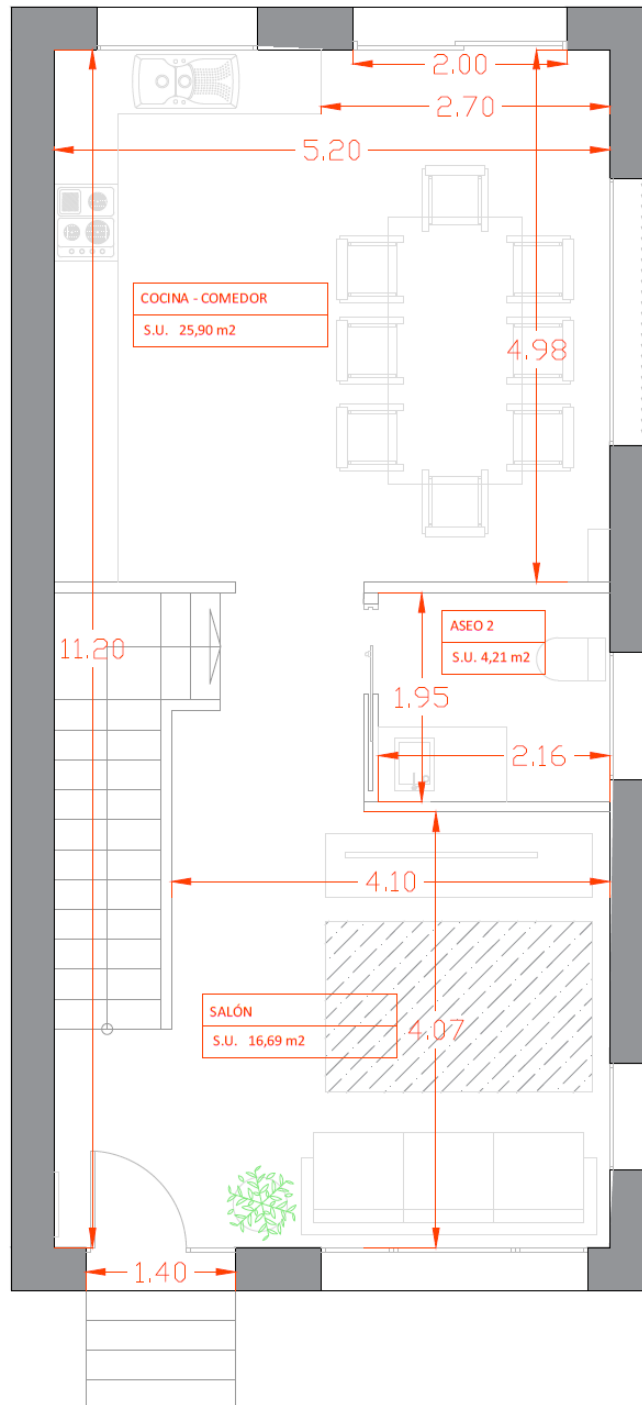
Plano superficies planta baja 2019. Fuente propia.
